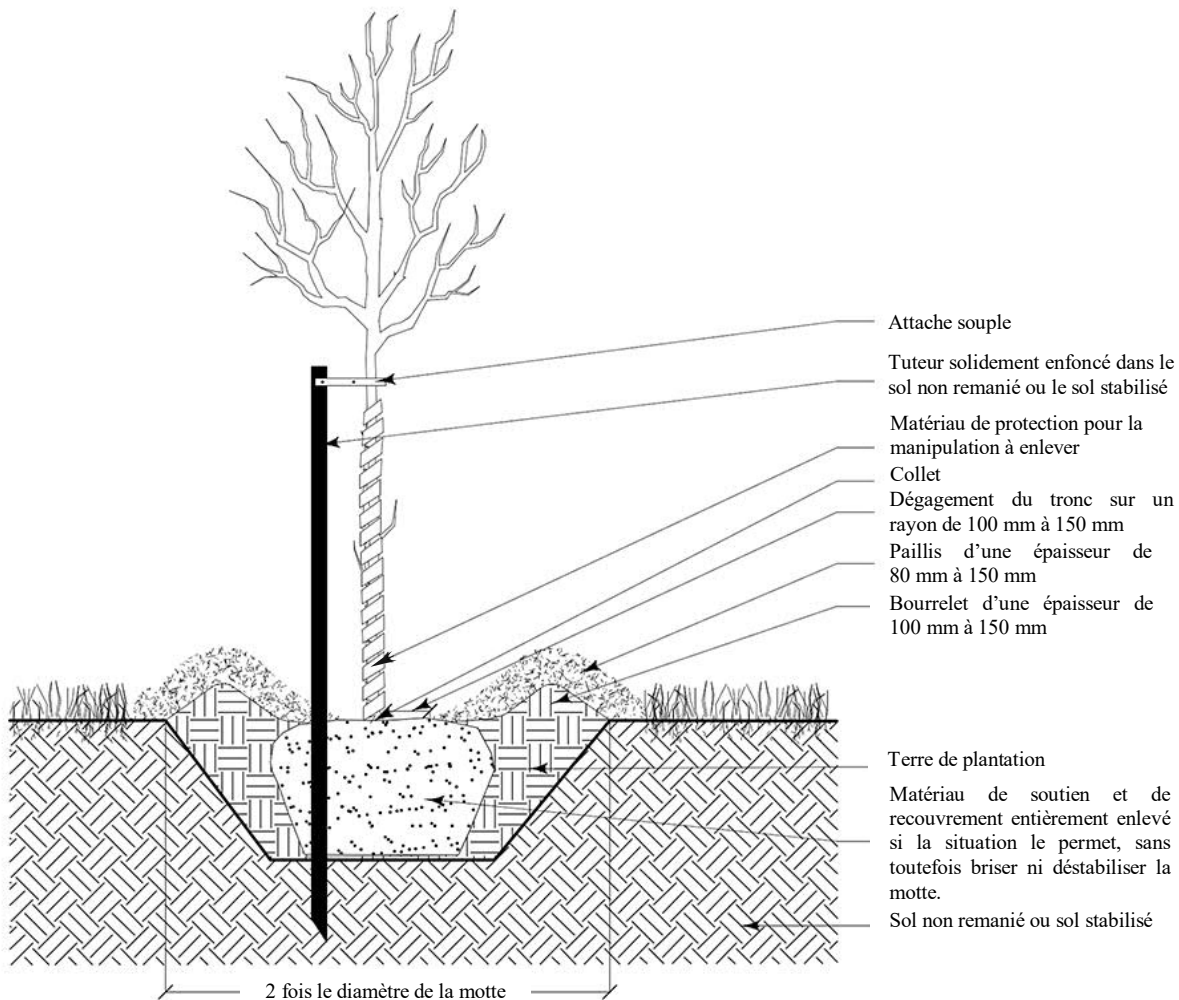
EXEMPLE DE PLANTATION D'UN FEUILLU STABILISÉ PAR UN TUTEUR (ENLÈVEMENT DE TOUT LE MATÉRIAU DE SOUTIEN ET DE RECOUVREMENT)
